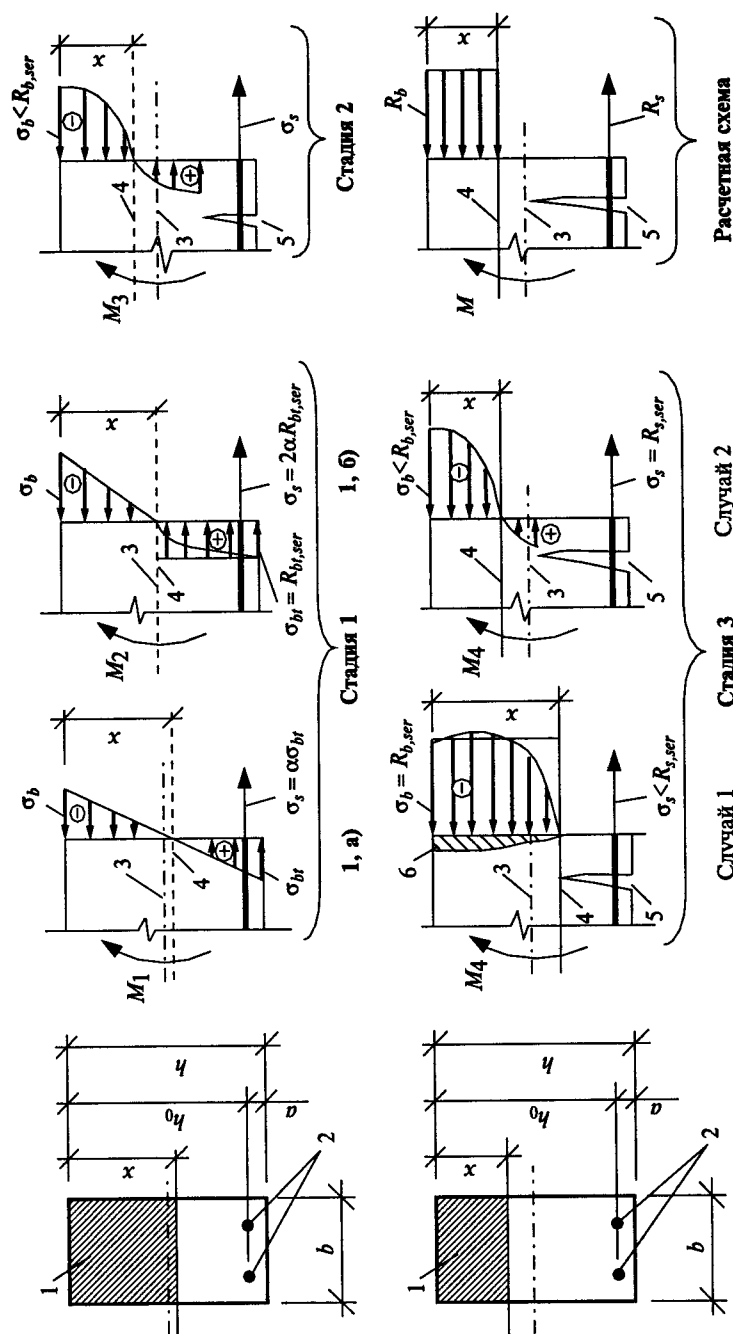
Стадии напряженно-деформированного состояния в нормальном сечении при изгибе железобетонной балки от начала работы до разрушения: 1 — сжатая зона бетона; 2 — арматура; 3 — центральная ось; 4 — нейтральная ось; 5 — трещина; 6 — зона разрушения бетона;  $M$  — изгибающий момент;  $M_4 > M_3 > M_2 > M_1$
